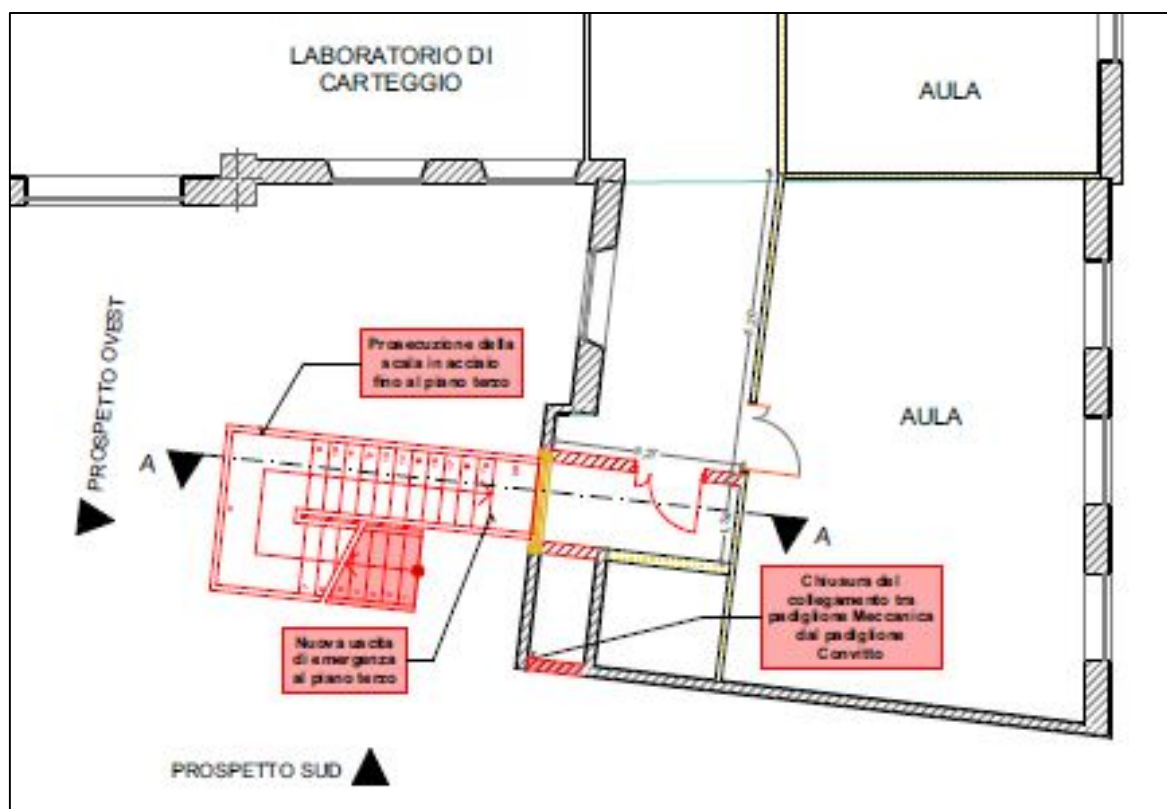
Sopraelevazione scala di emergenza esterna: pianta piano terzo
